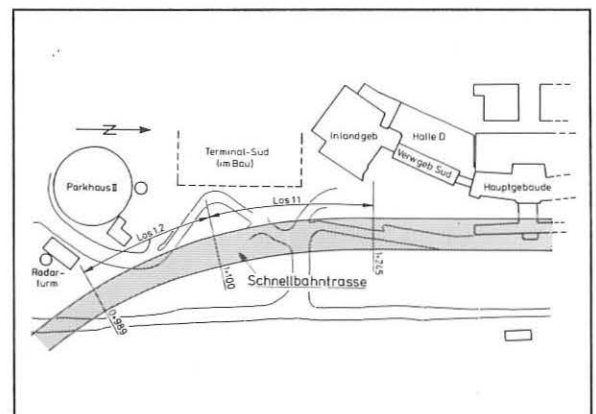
Vorwegbauwerk Flughafen Hamburg, Übersichtslageplan
